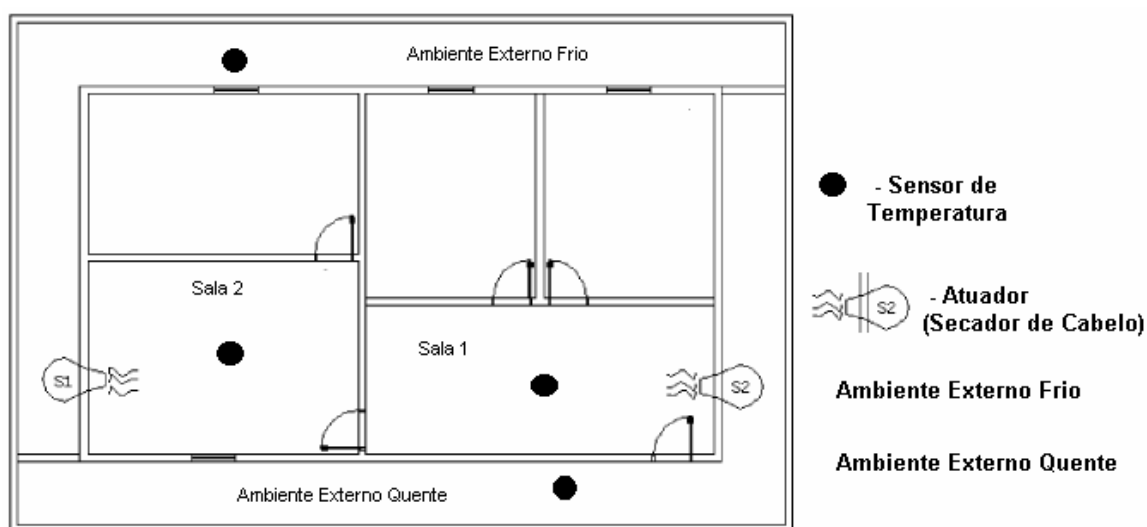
Planta baixa da maquete [6], com adaptações.
